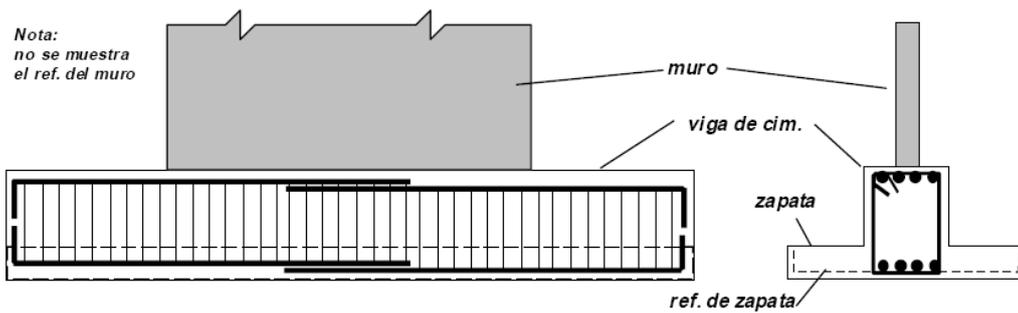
Refuerzo de zapata de muro y viga de cimentación
